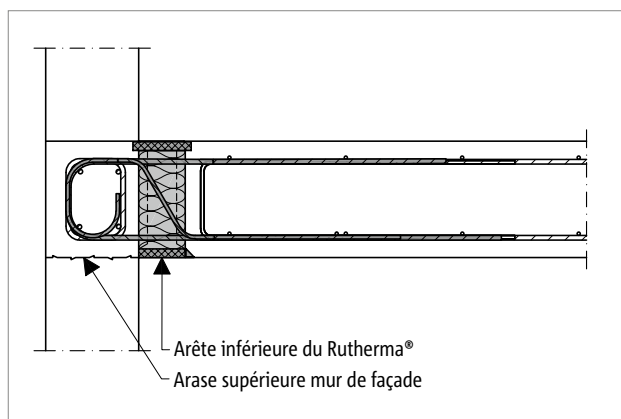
Schöck Rutherma® T type DF*i* : dalle en béton coulé sur place et façade en béton armé
